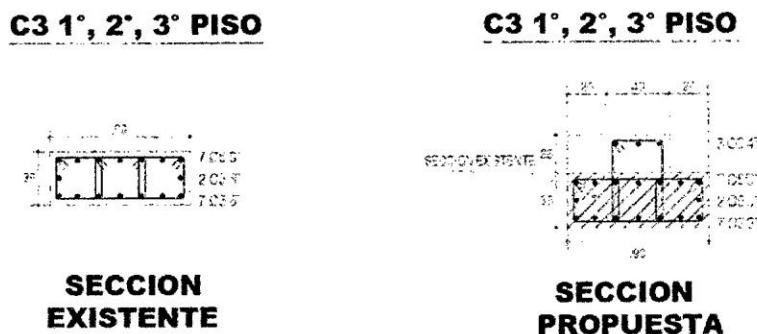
Sección propuesta de las columnas C3 a sección T para mejorar el desempeño del edificio
